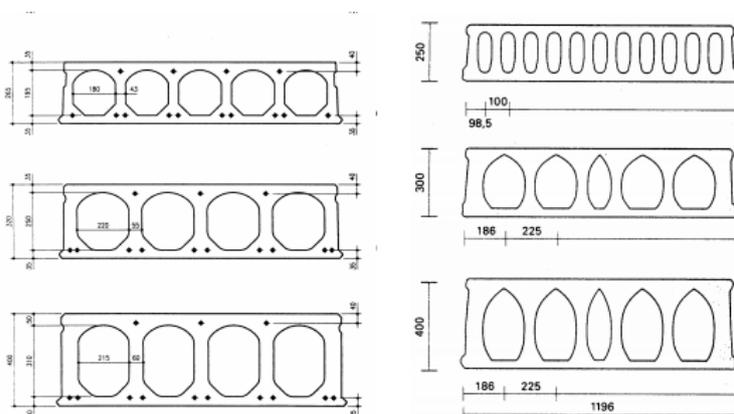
Seções transversais típicas de lajes protendida pré-moldada.
